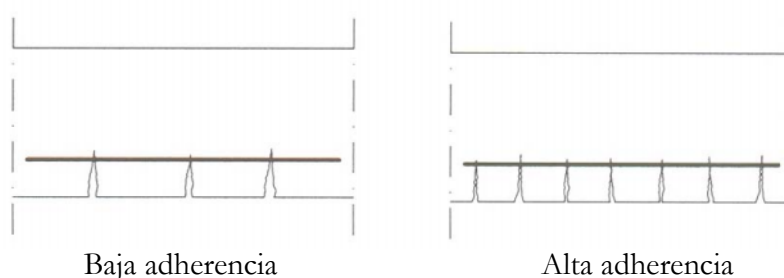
Influencia de la adherencia en la fisuración del hormigón. Viga a flexión
